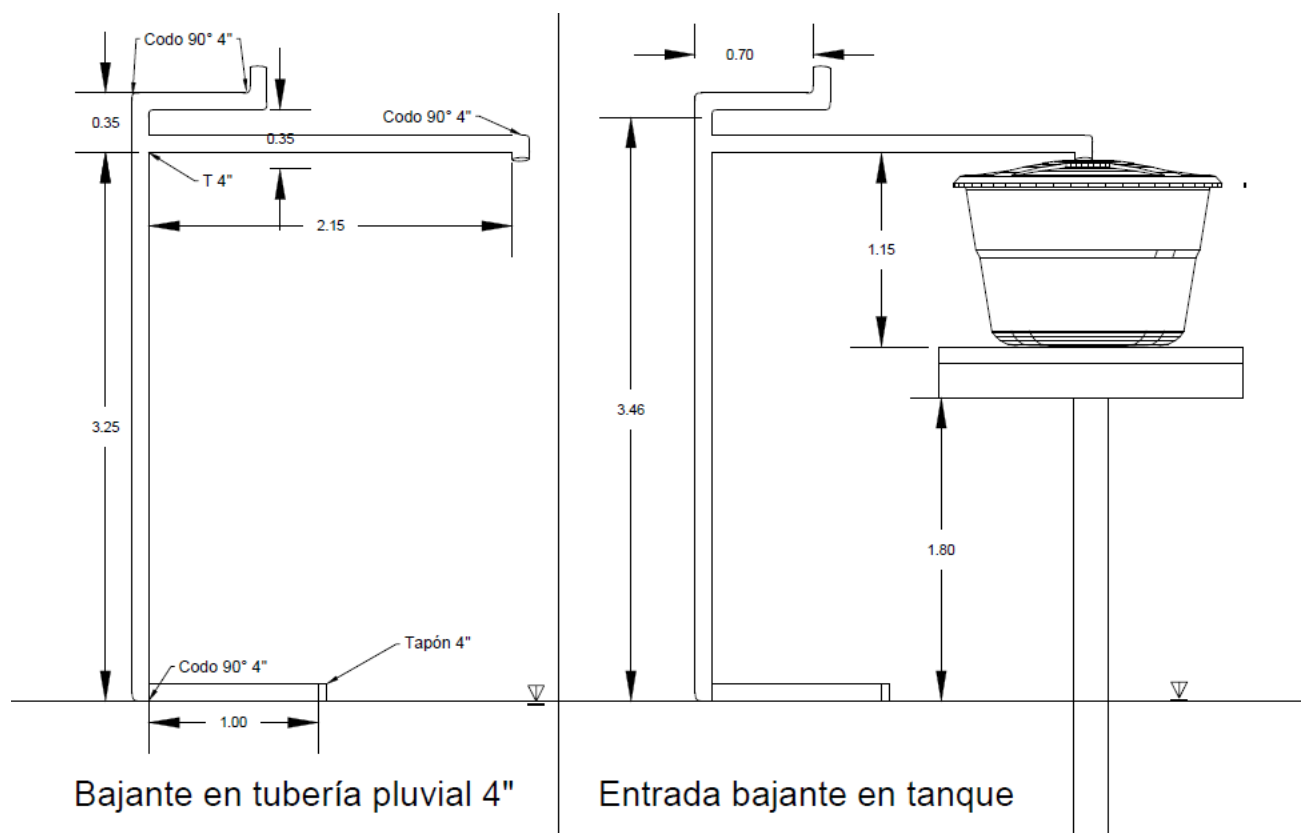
Bajante y detalles desde cubierta a tanque receptor.
